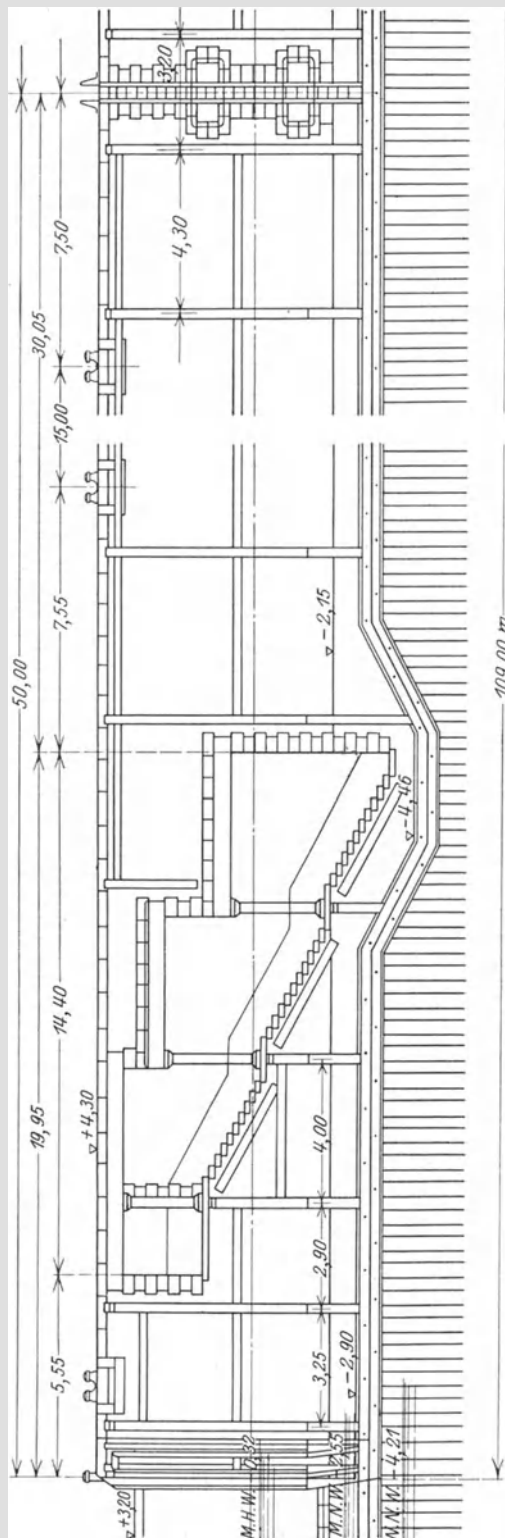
a. Ufermauer mit Treppenanlage. Maßstab 1 : 200.
